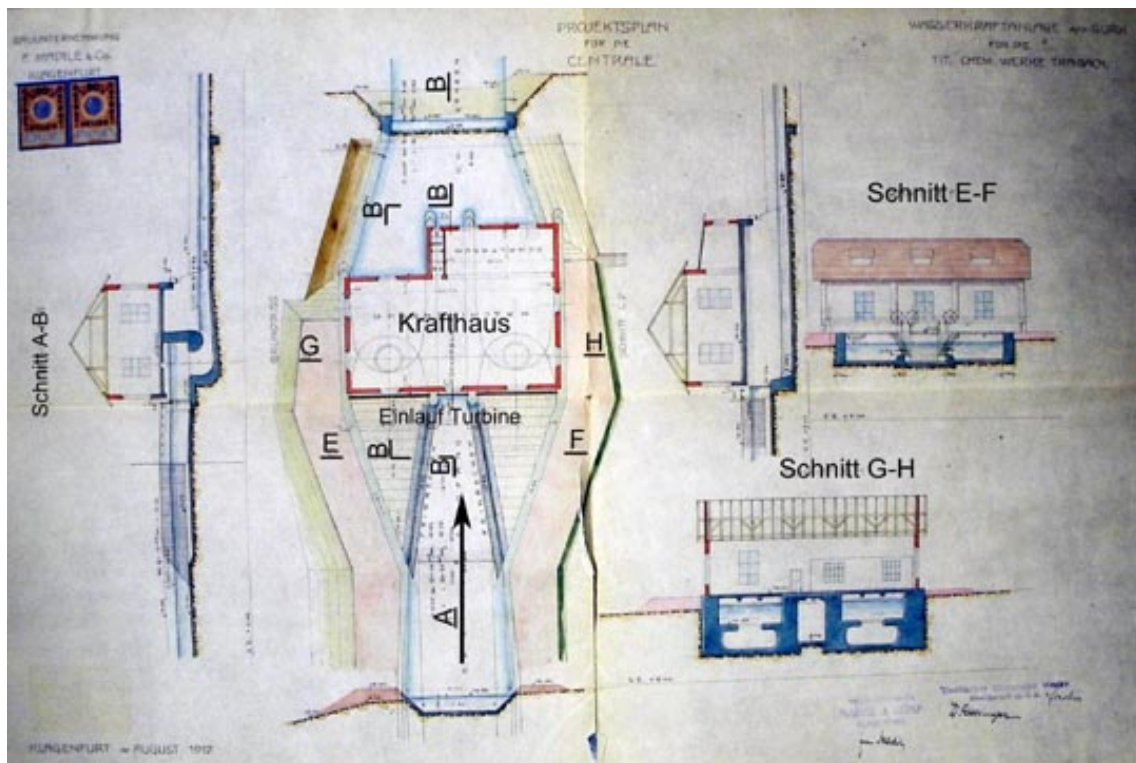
Grundriss und Schnitte des Krafthauses (1917)
